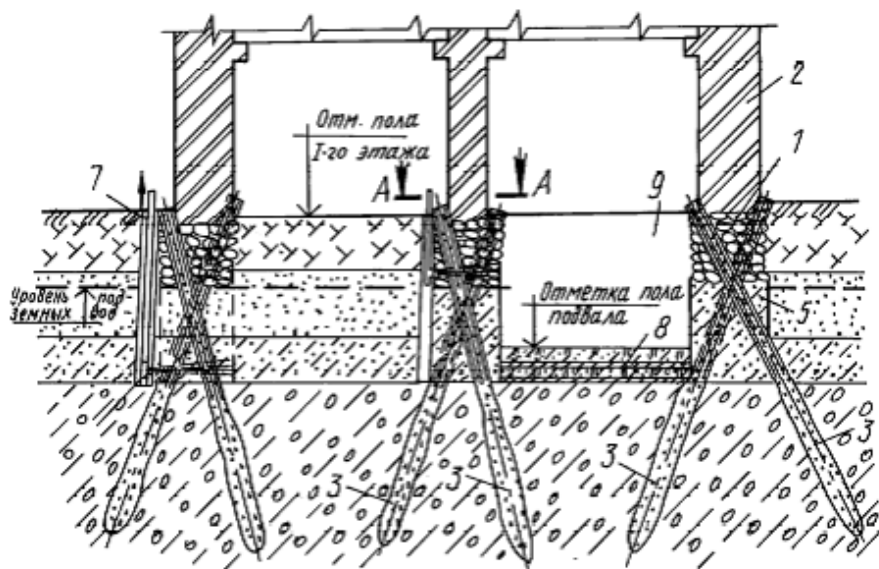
Способ реконструкции зданий, сооружений (а.с. RU2065001 C1 E02D 35/00) 1- фундамент; 2 -несущая стена здания; 3 –буроинъекционная свая; 4 – вертикальные шлицевые прорези; 5 – грунтоцементный массив, образующий стены здания; 6- закрепляющий раствор, подаваемый из сопла монитора; 7 – скважина для погружения монитора; 8 – противofильтрационная завеса; 9- подвальное помещение
